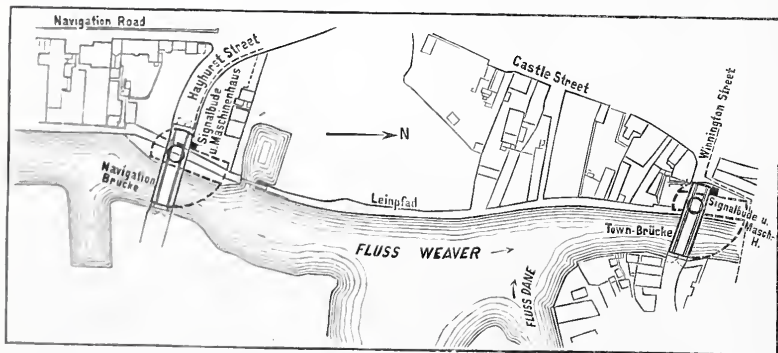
Lageplan der Weaver-Brücken bei Northwich. (Etwa 1:3600).
